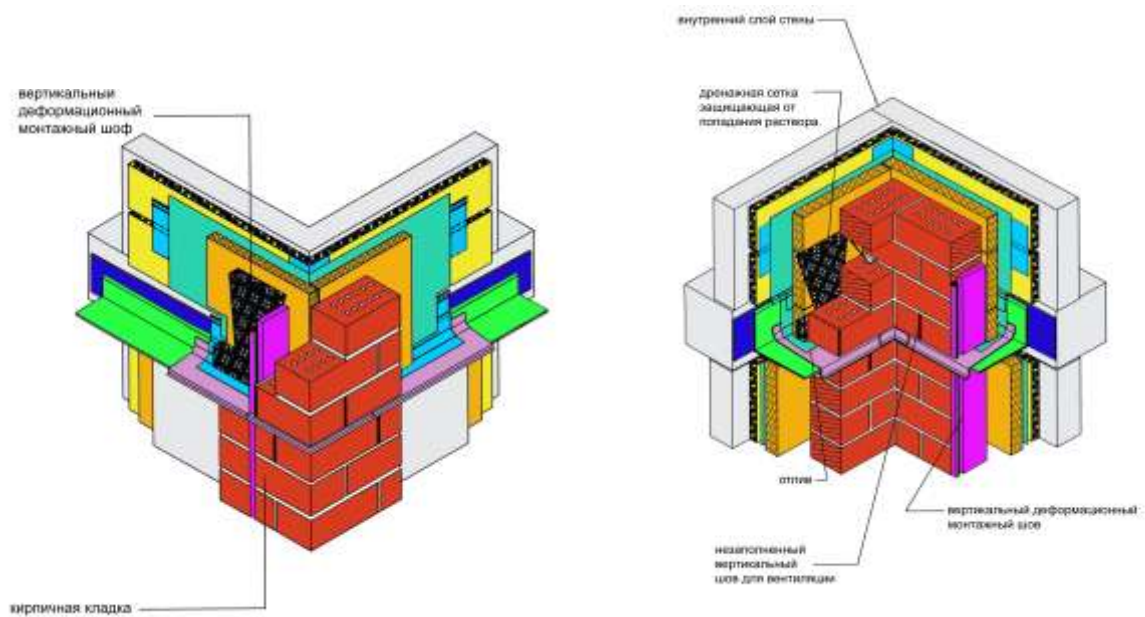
Техническое решение конструкции трехслойной стены на внешнем углу
